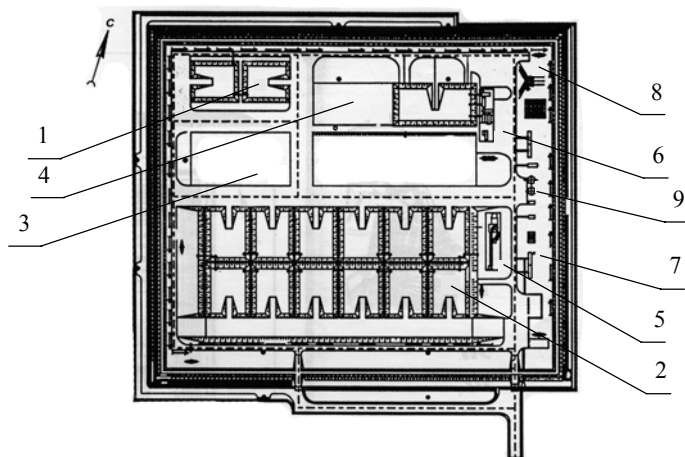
Генеральный план полигона по хранению и утилизации нефтесодержащих отходов /815/
